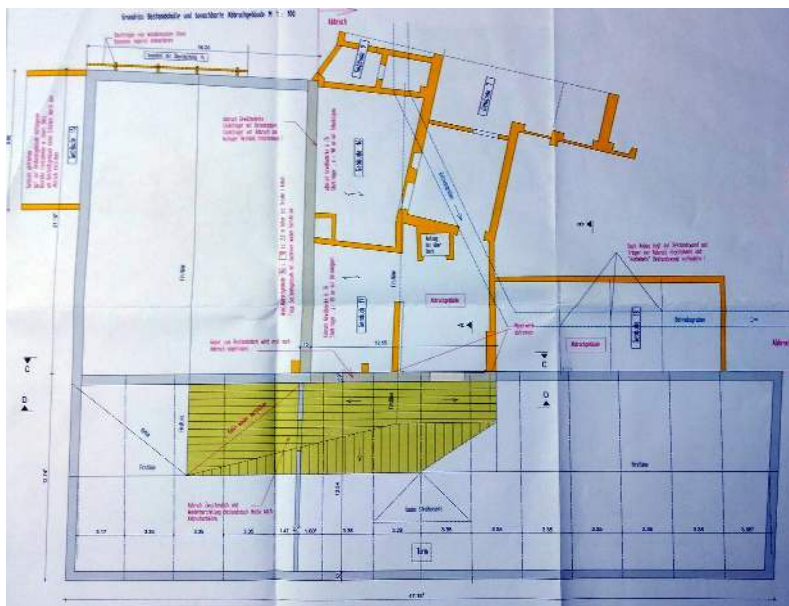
Grundriss; gelb = nicht mehr vorhandene Substanz
